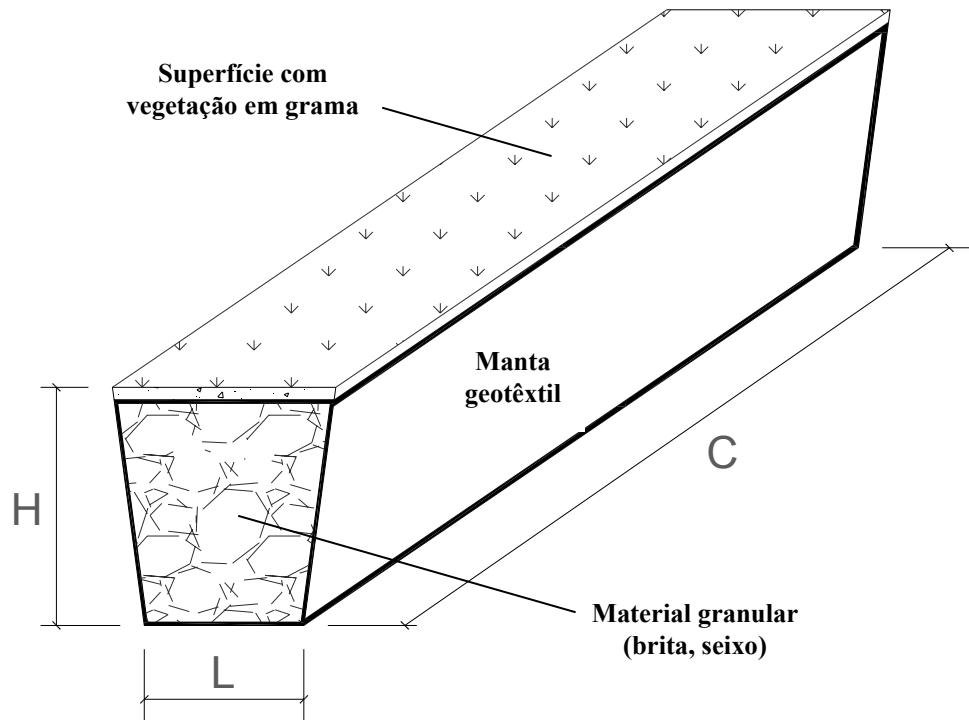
Corte em perspectiva e especificação técnica de uma trincheira de infiltração.
